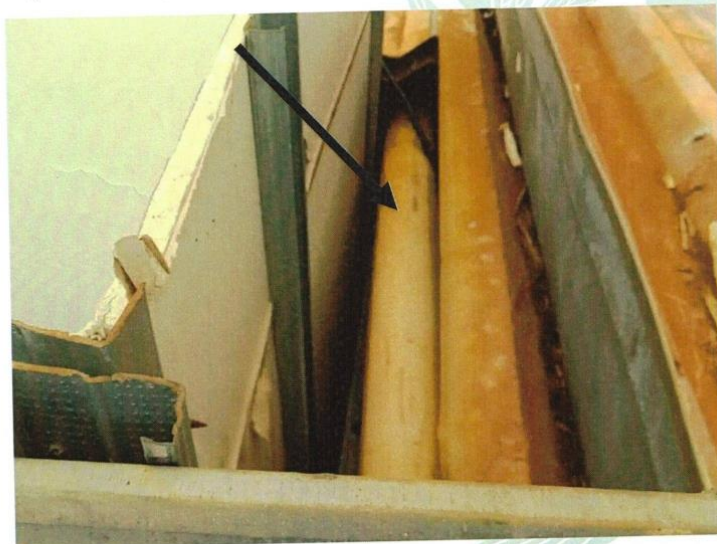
Possível área de infiltração entre a parede e as telhas (Fonte: Luís Gustavo, no local)
